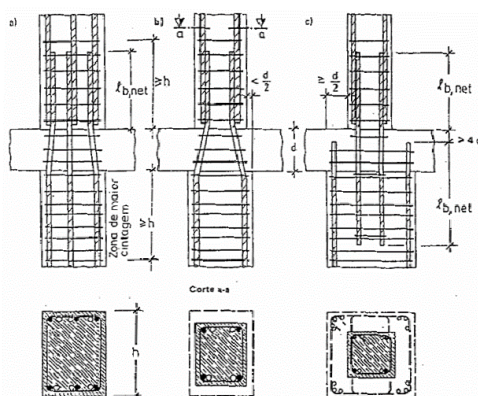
Zonas de cintagem e ligação entre vigas e lajes (Félix, Guedes e Neves, 2014).
